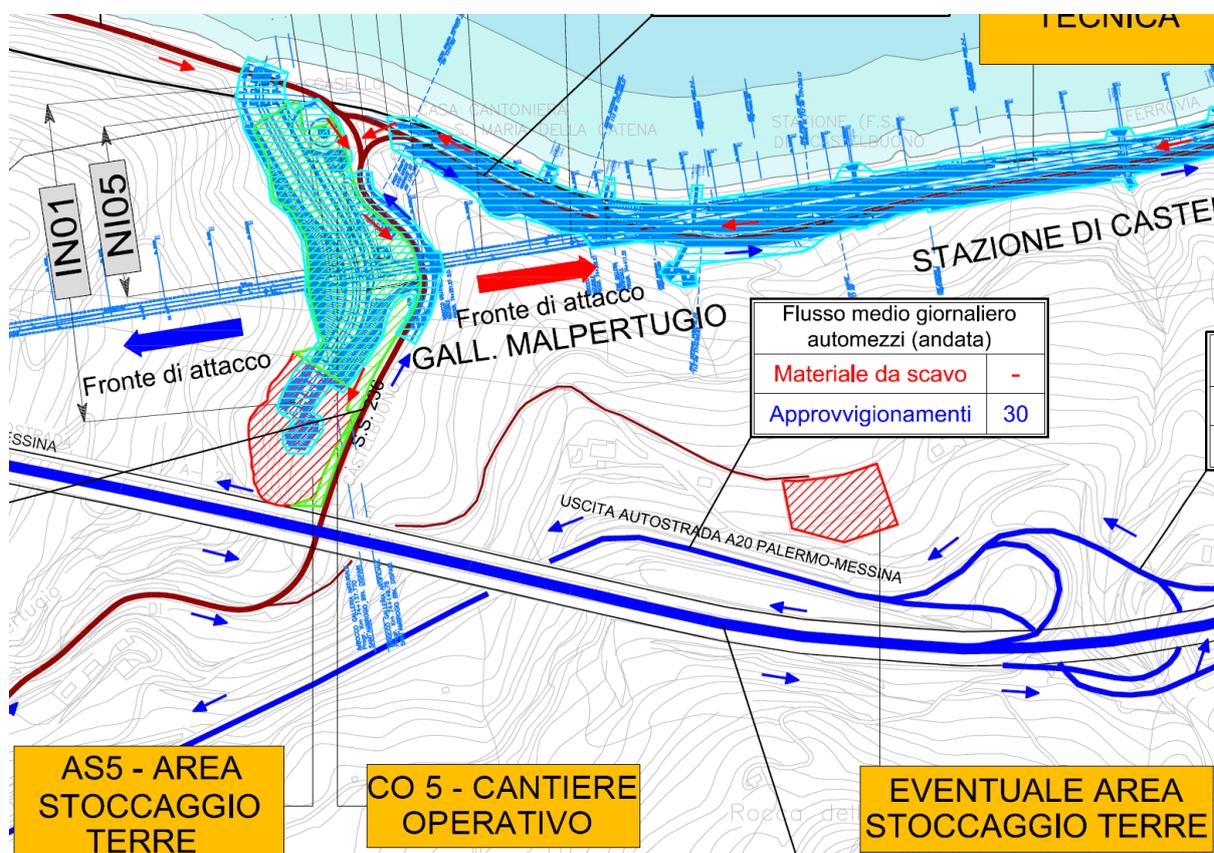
Stralcio planimetrico della Zona Malpertugio, con indicazione delle aree di cantierizzazione AS5, CO5 e di un'altra eventuale area di stoccaggio posta a Sud della Stazione di Castelbuono.
